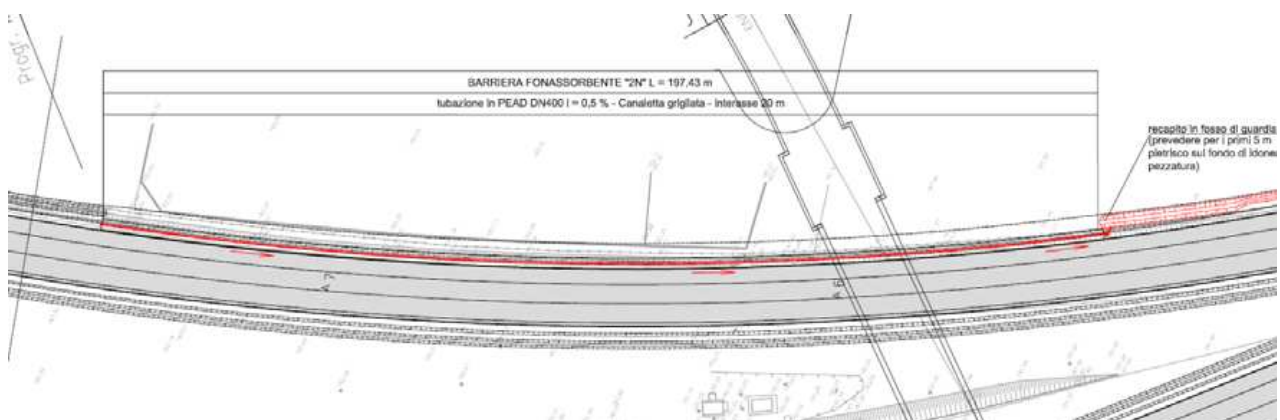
Estratto planimetrico opere idrauliche piattaforma rampa MI-CO
